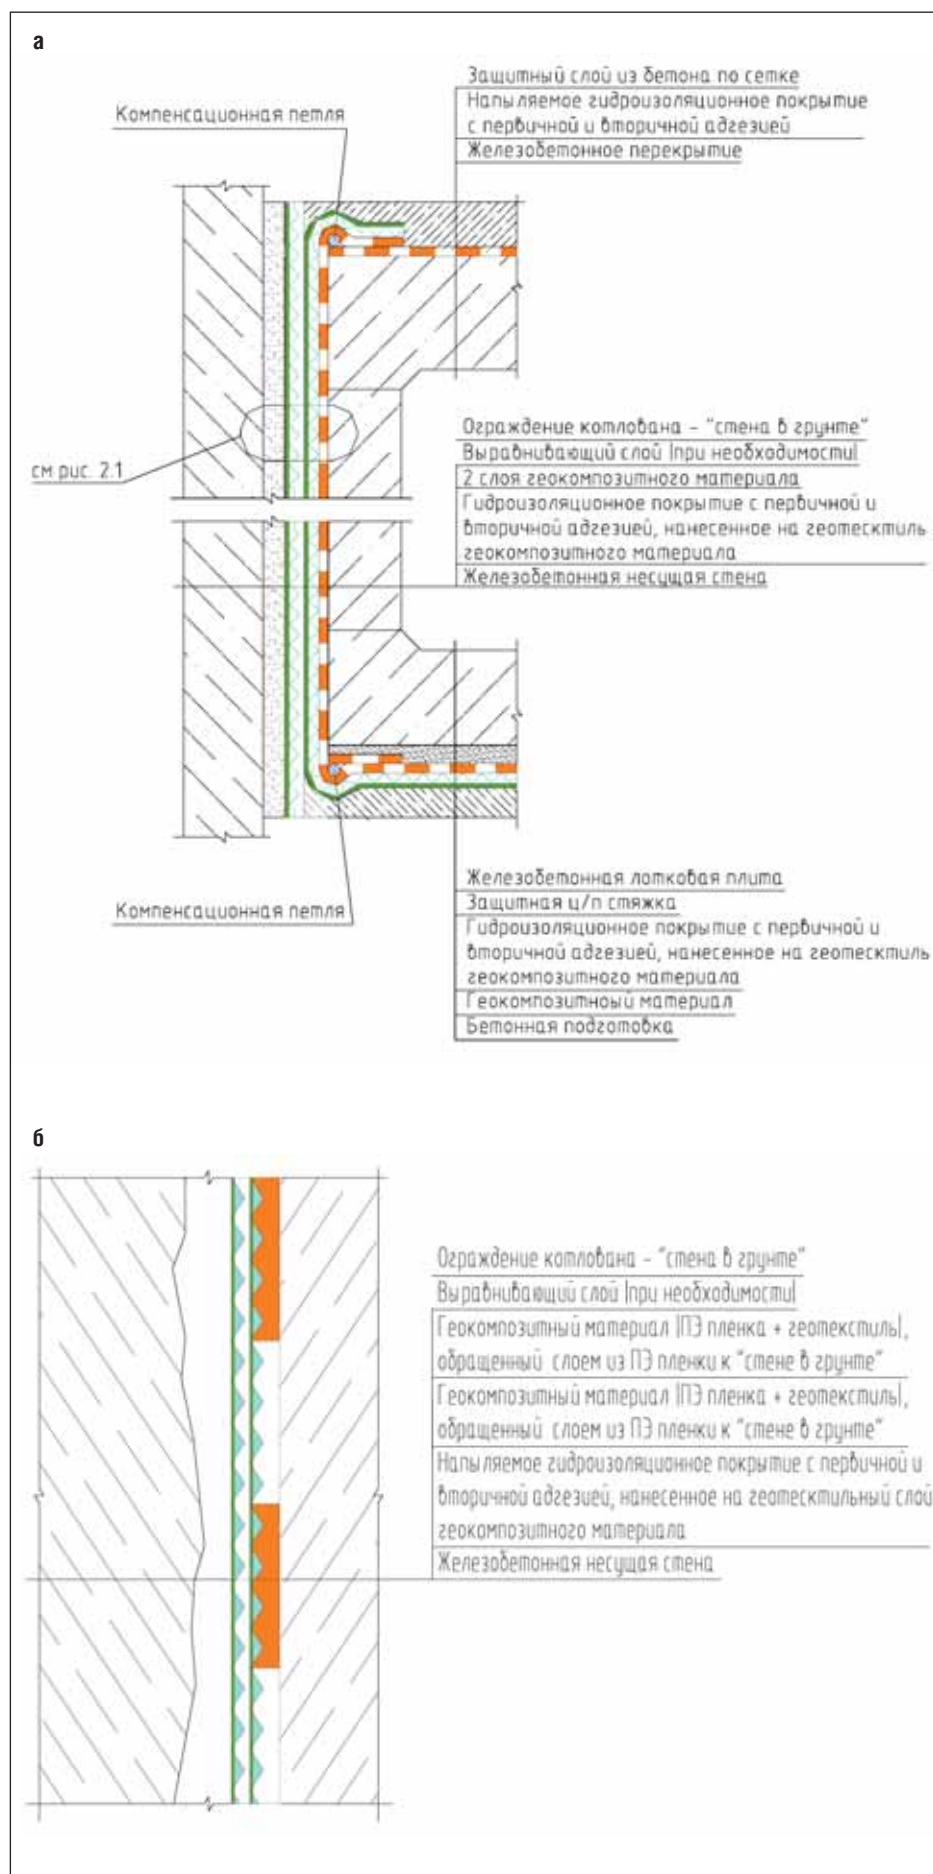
Устройство комбинированной гидроизоляции тоннельного сооружения при открытом способе работ с использованием «стены в грунте» в качестве несъемной опалубки: а – общий вид; б – узел при-
